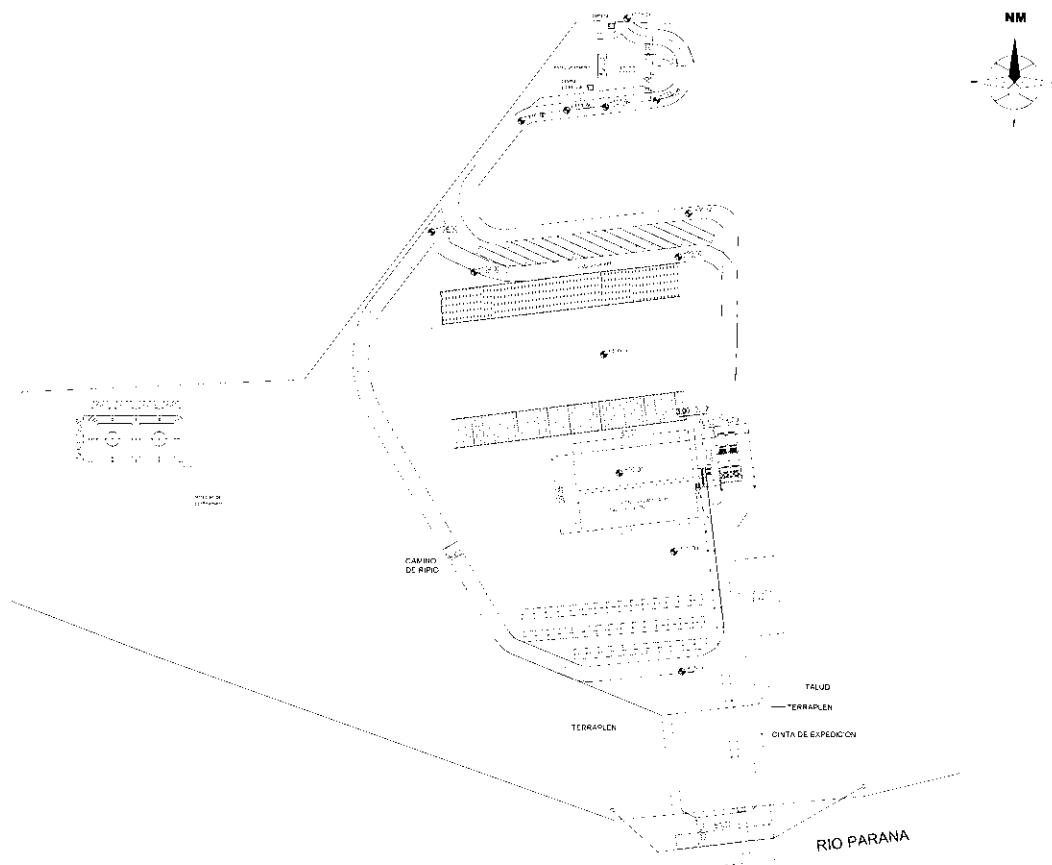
Plano Esquemático de la Disposición de las Instalaciones
